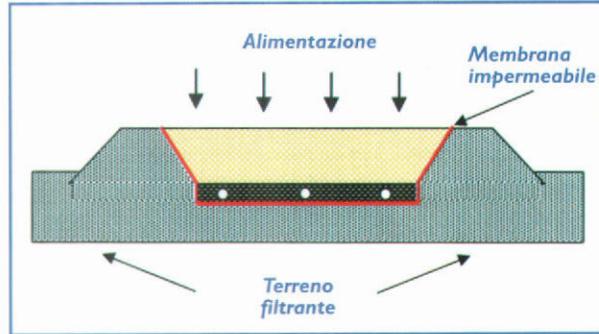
Sistema a massa drenante a tenuta garantita da un membrana impermeabile (Agences de l'Eau, 1993)
